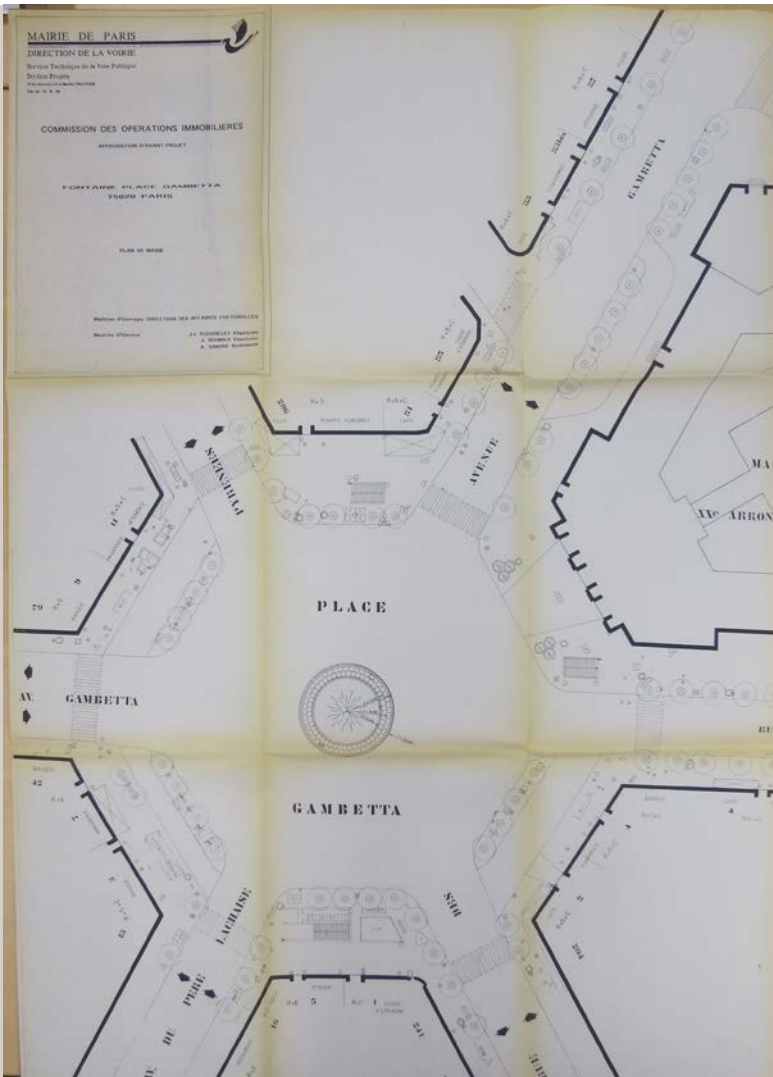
Plan masse du projet de fontaine place Gambetta, 1990.
